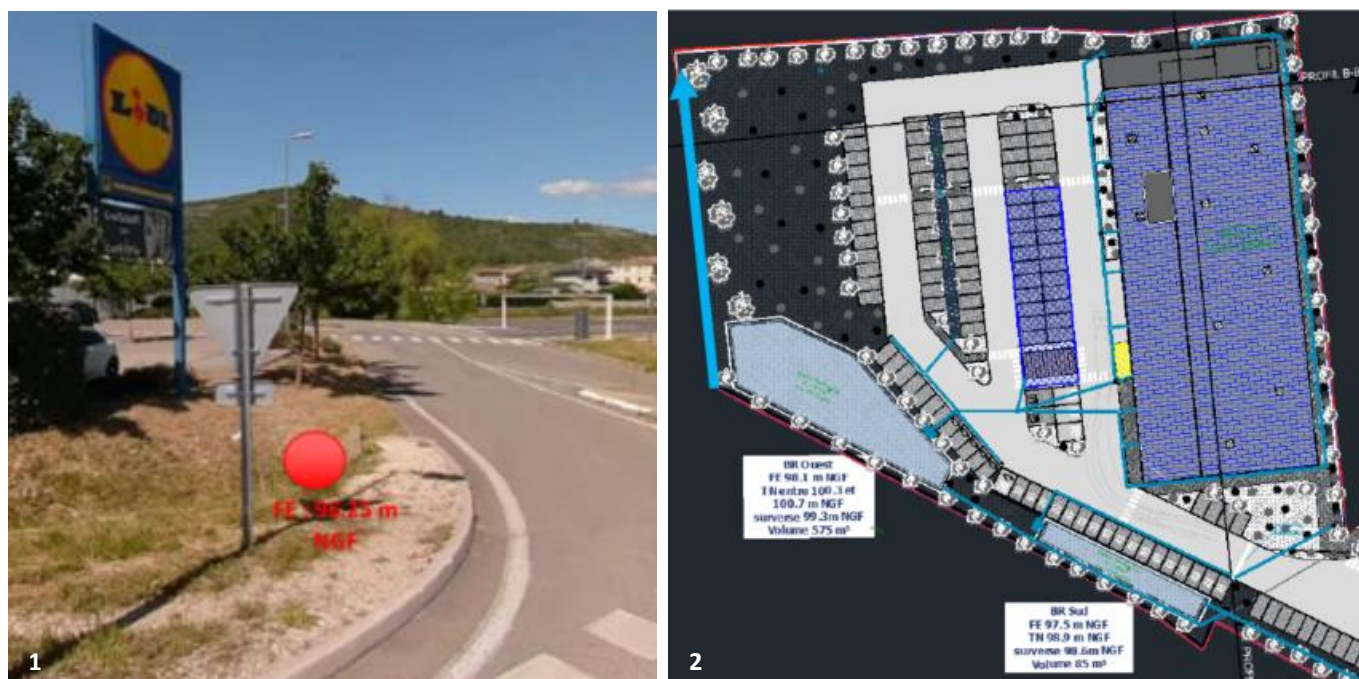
Localisation du point de rejet des eaux pluviales (1) et des deux bassins (2) (Source : Notice hydraulique – CEREG – Avril 2021)
